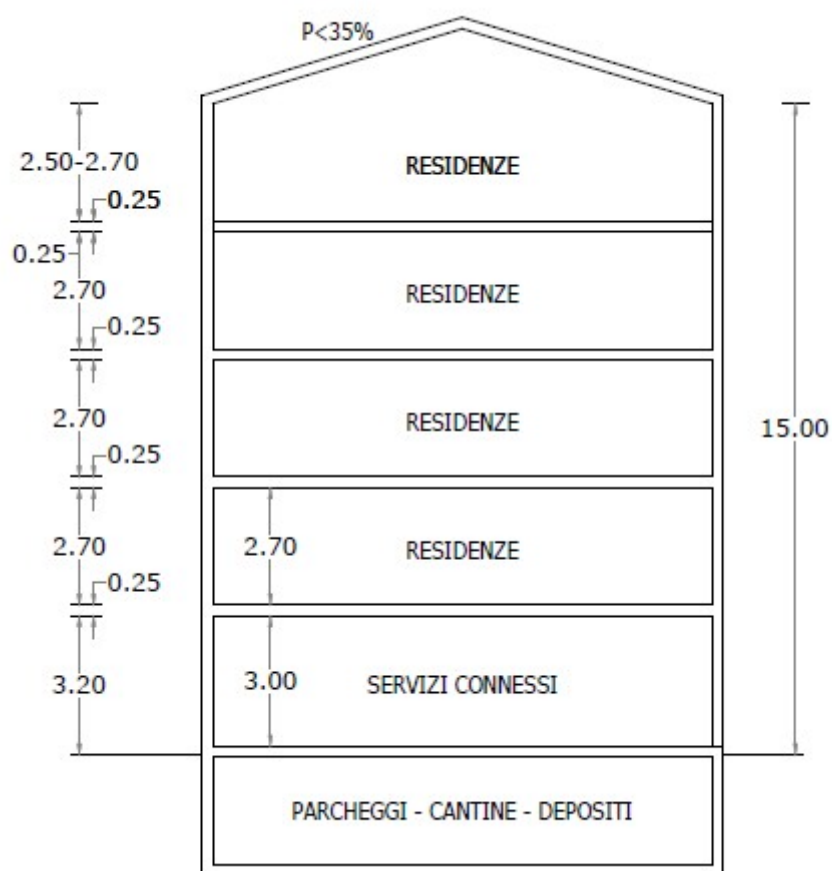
Schema sezione lotti 1 e 2 – stralcio 1
